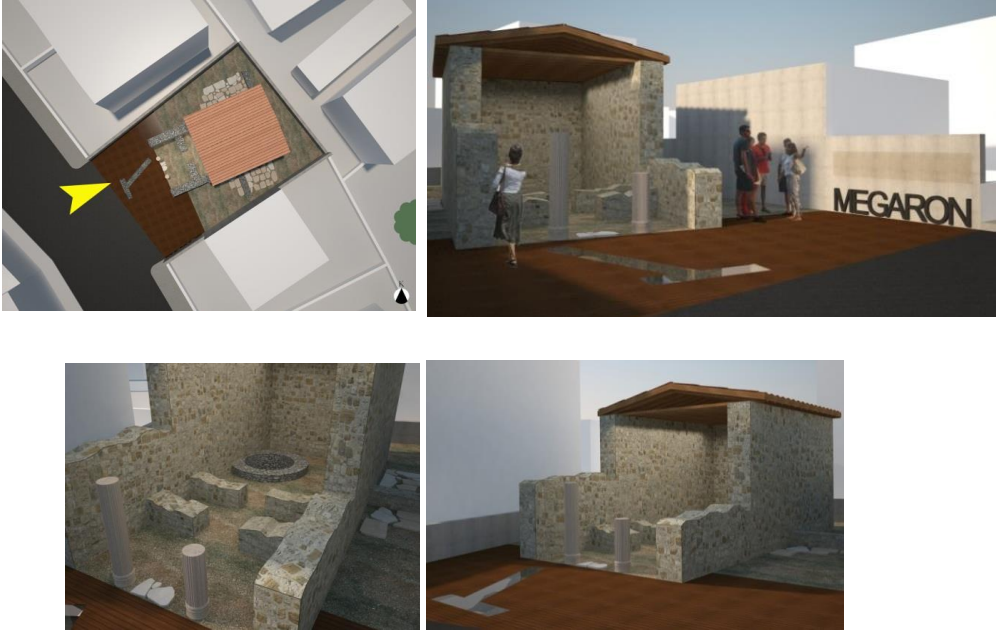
Çalışma alanı ve çevresinin vaziyet planı
